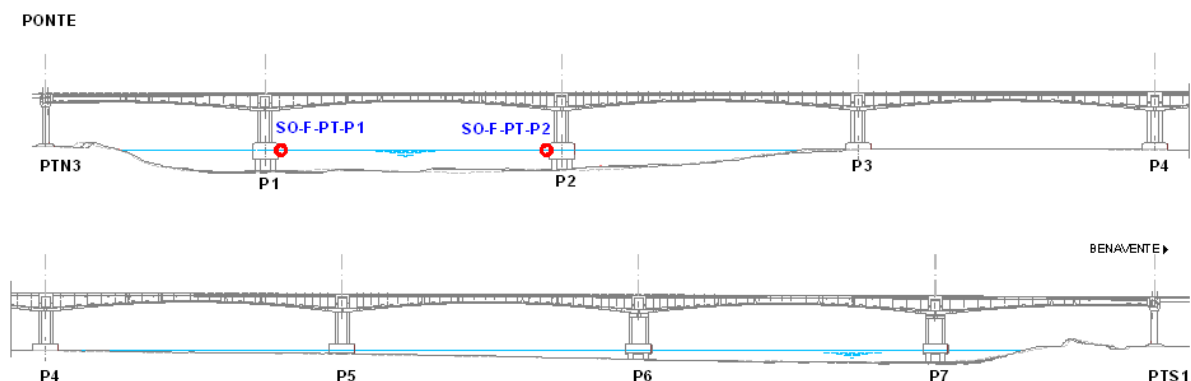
Corte Longitudinal da Ponte com localização do equipamento de monitorização da infra-escavação nos maciços dos pilares P1 e P2 (canal de navegação)
